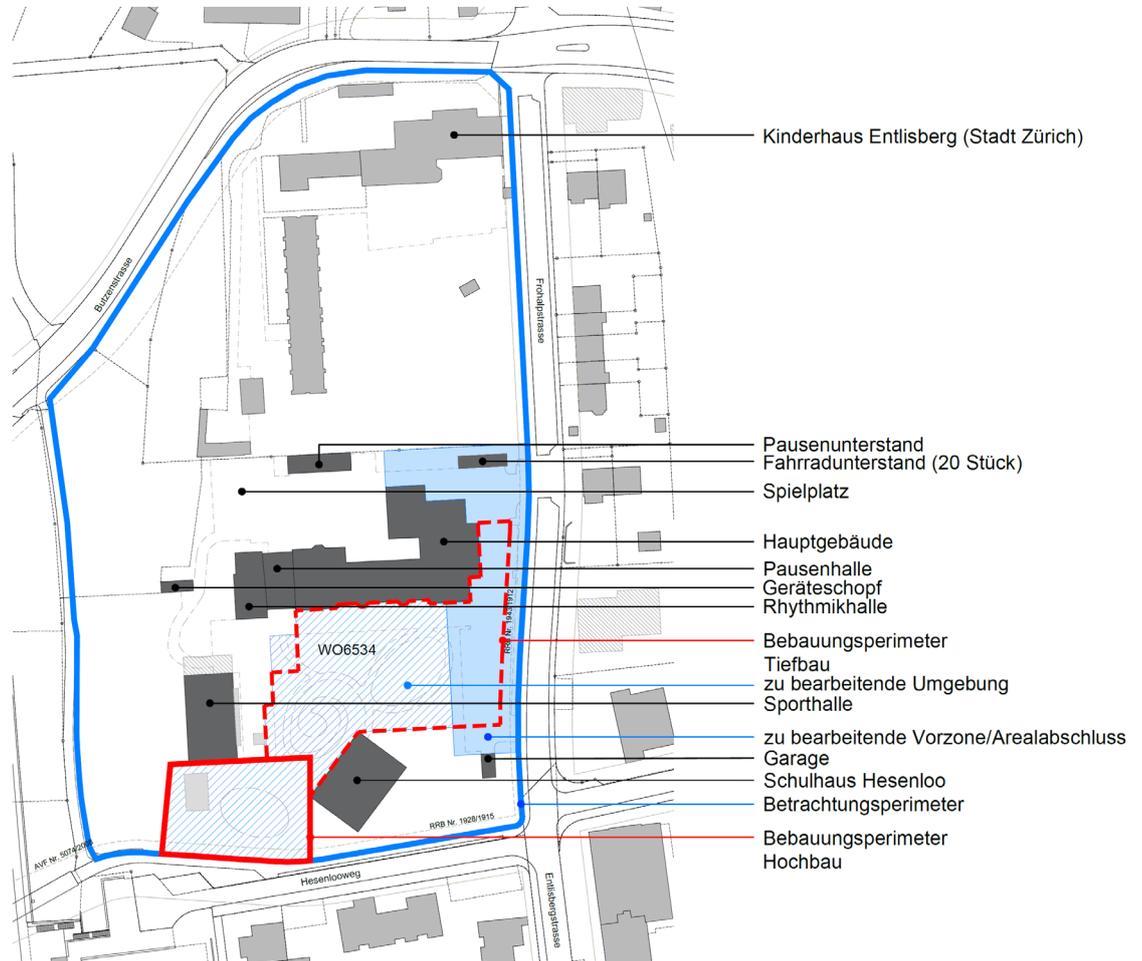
Bebauungssperimeter Hochbau/Tiefbau und Betrachtungssperimeter, ohne Massstab, genordet
